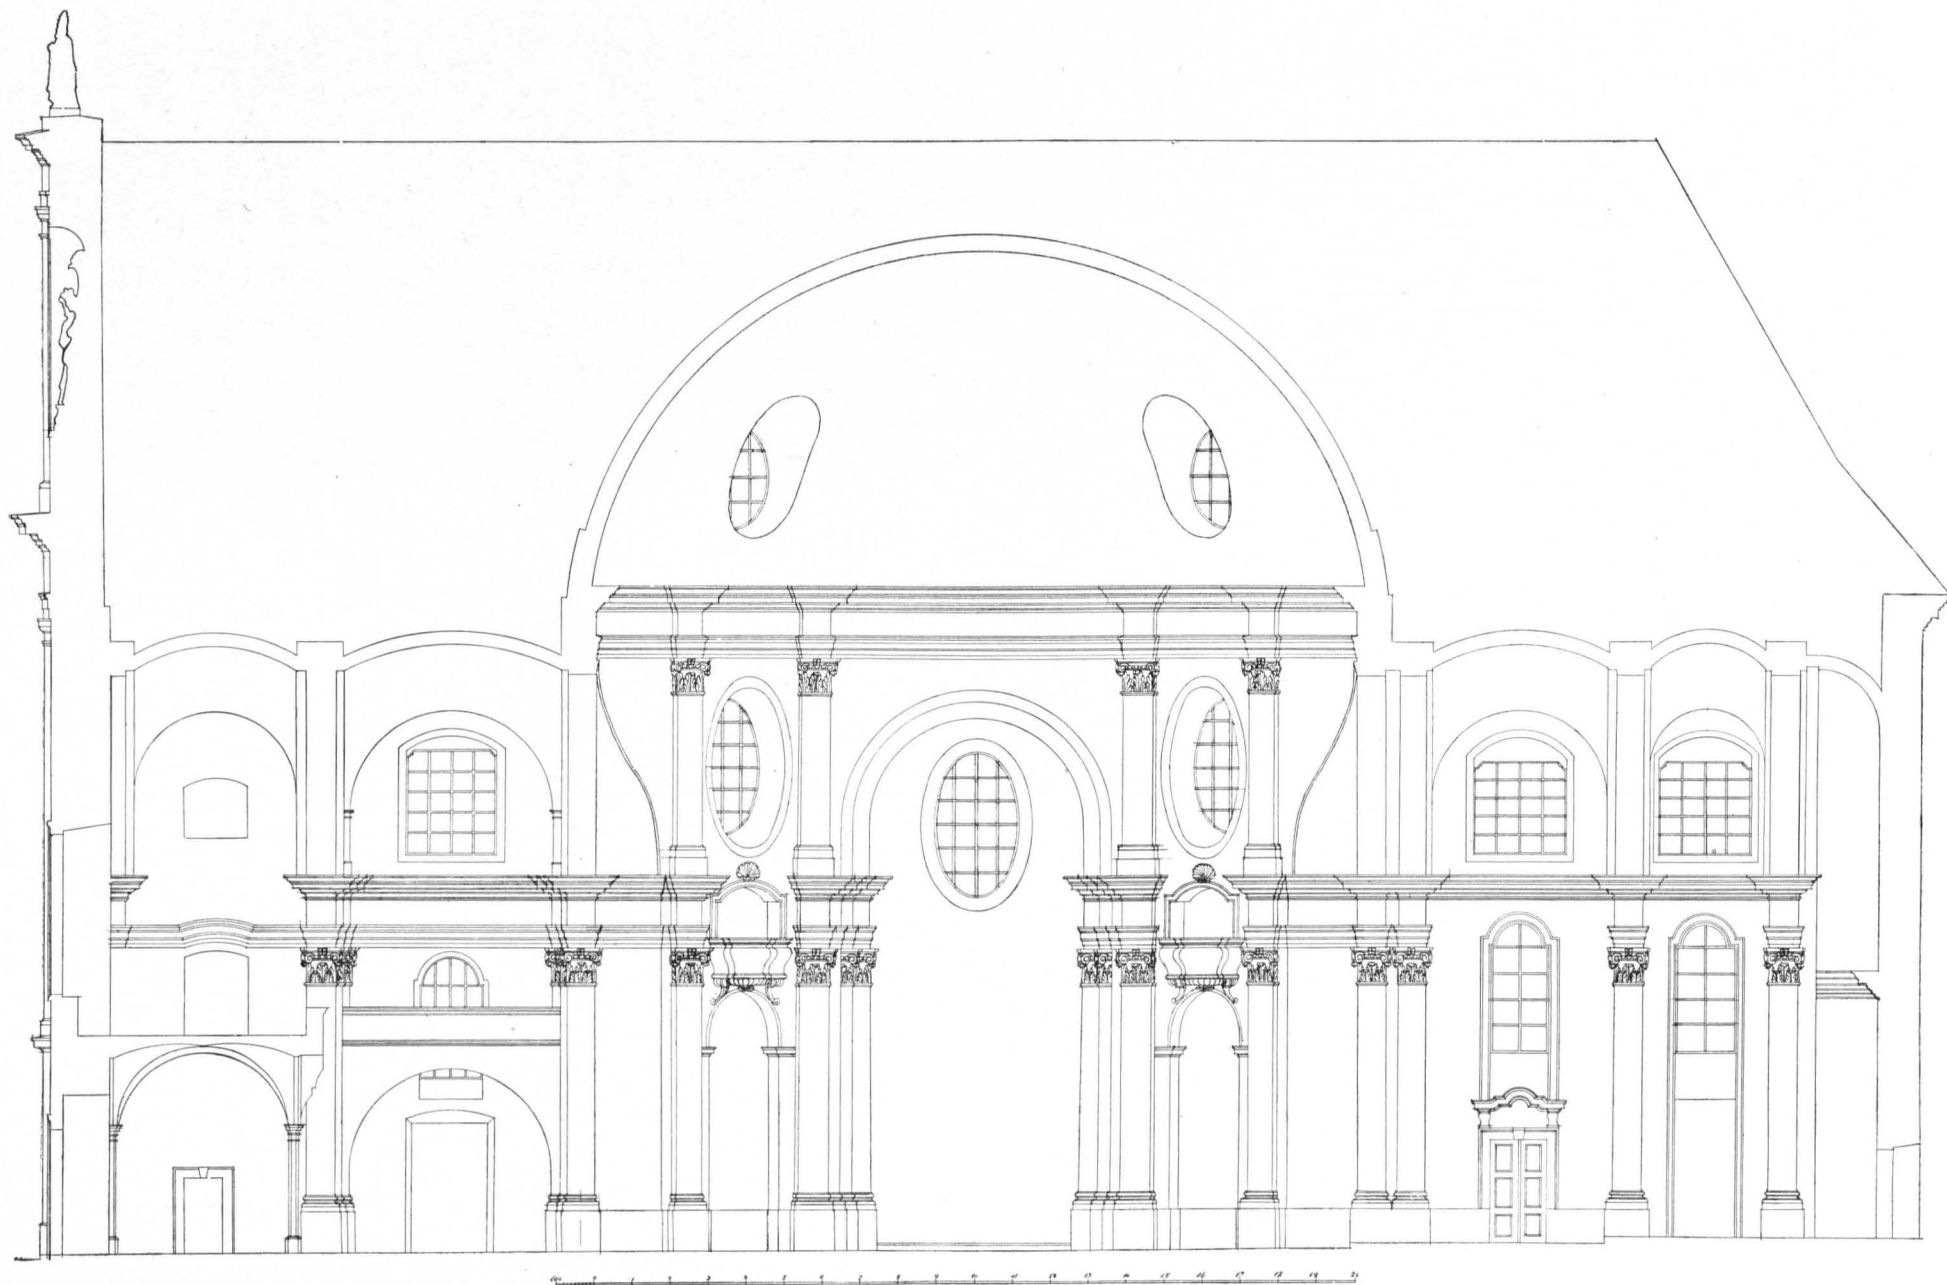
Dreieichen, Pfarrkirche, Längenschnitt 1 : 200 (S. 426)
